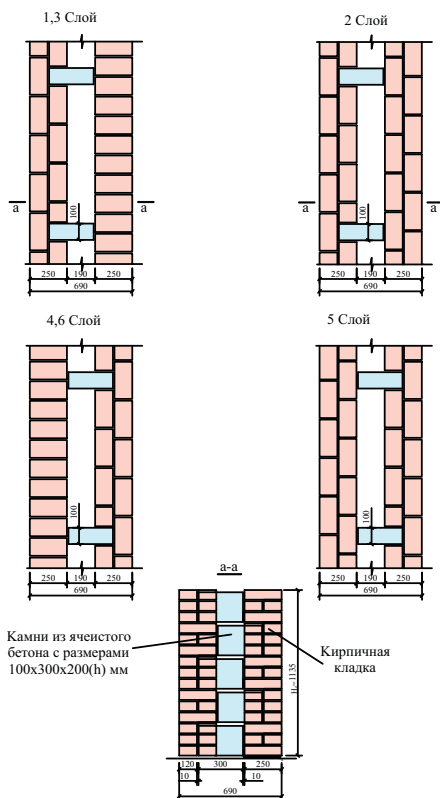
Наружная стена с самонесущими наружным и внутренним слоями с вертикальными диафрагмами из ячеистобетонных камней высотой до пяти этажей (тип ЯД-2)
